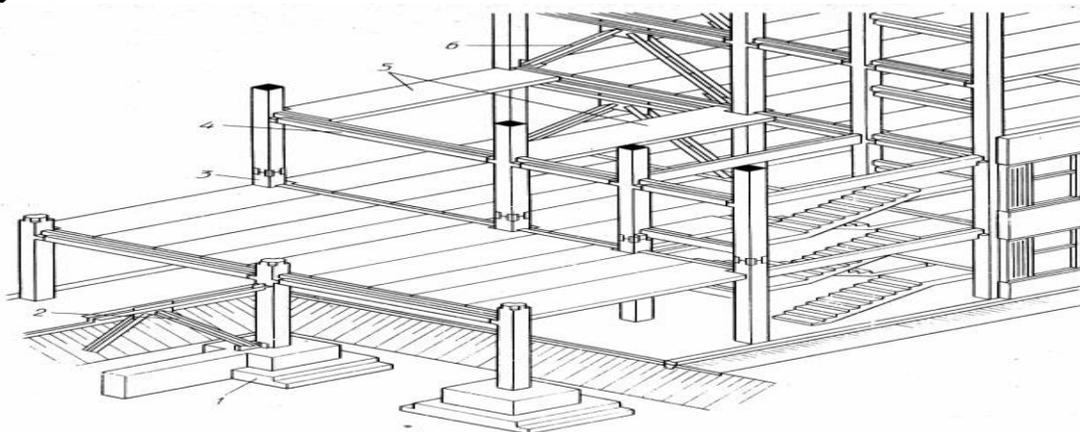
Шарнірно-зв'язний каркас: 1 – фундамент; 2 – подовжні зв'язки; 3 – колона; 4 – проліт; 5 – зв'язні плити; 6 – поперечні зв'язки.
